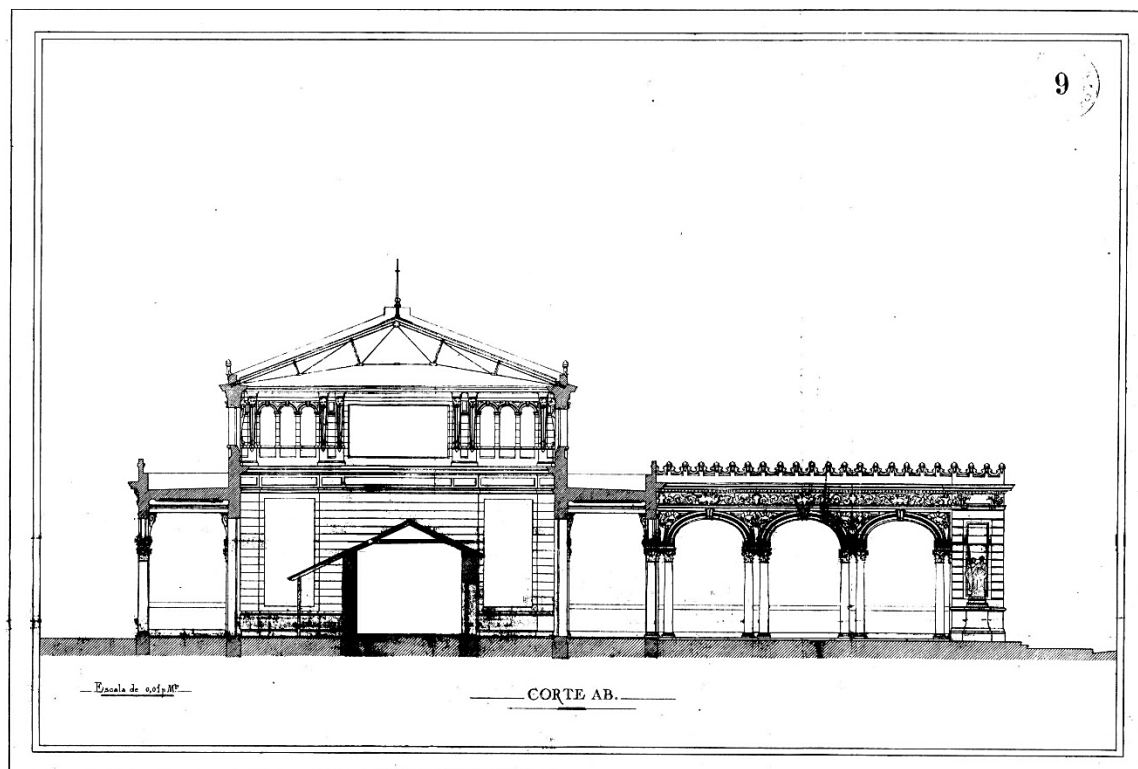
Corte Vista del proyecto original. Plano N° 9 DNOA
